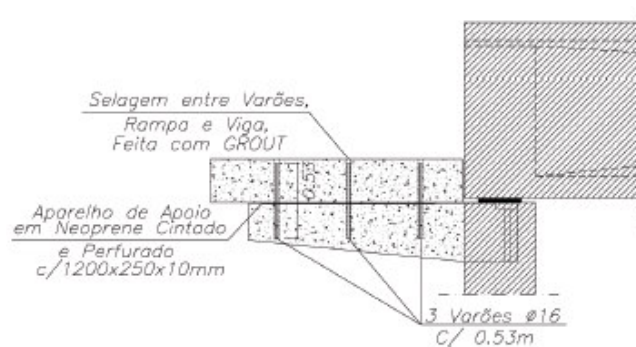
Pormenor de ligação rampa-pilar principal [14].
